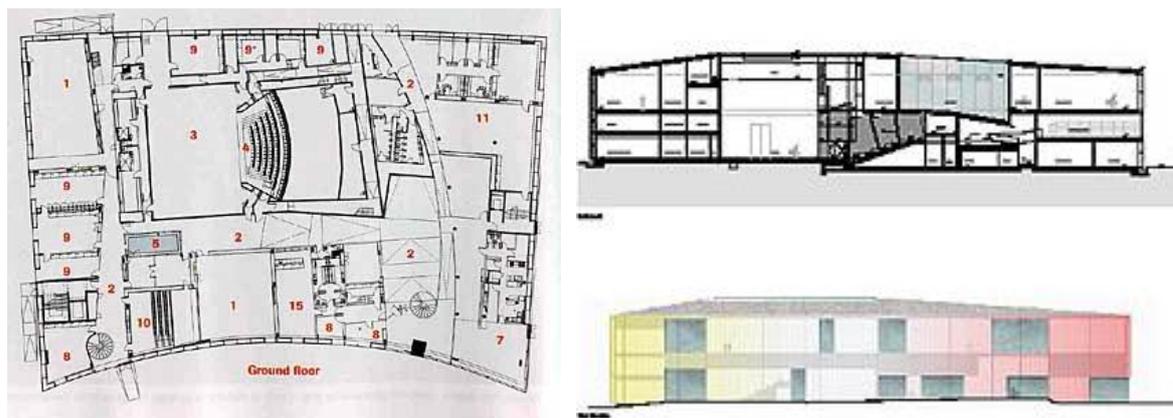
a 152: Planta baixa, corte e fachada esquemática.
